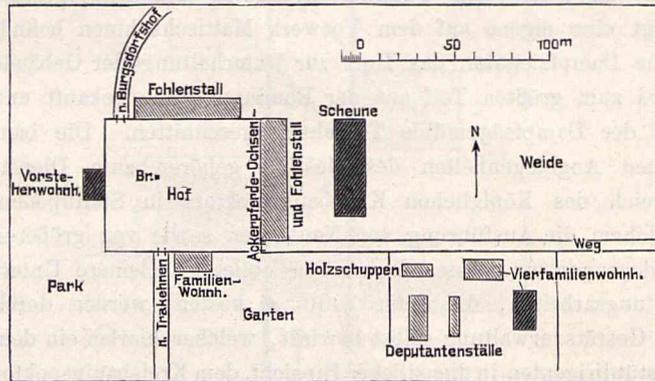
Vorwerk Birkenwalde. Lageplan.
